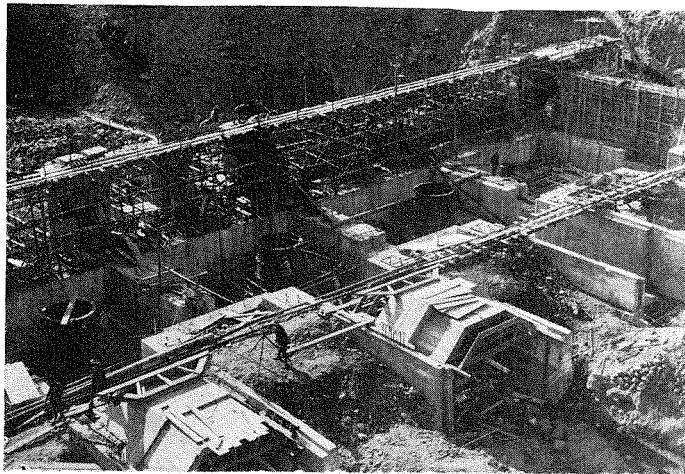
発電所基礎ドラフトチューブライナー据付、周囲建家基礎コンクリート施工。
